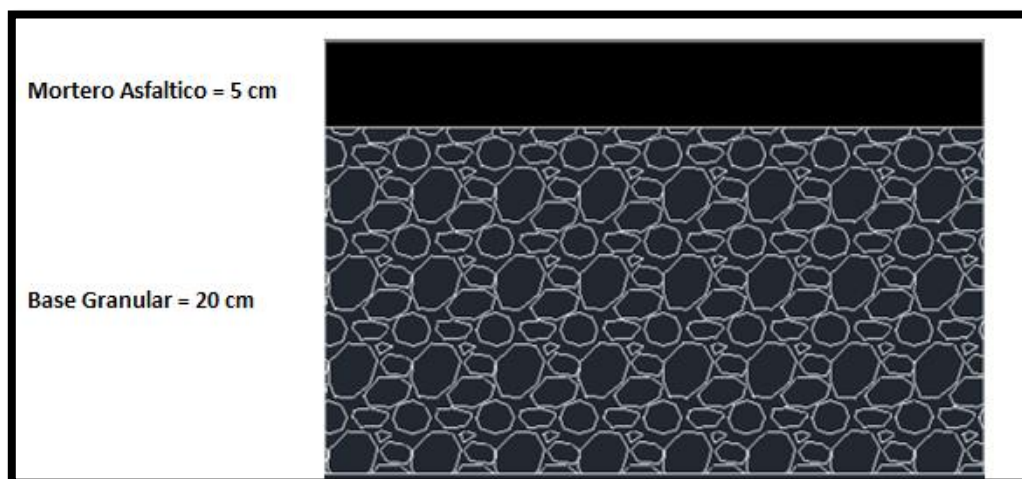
Estructura de pavimento tramo 00+000 – 10+687
